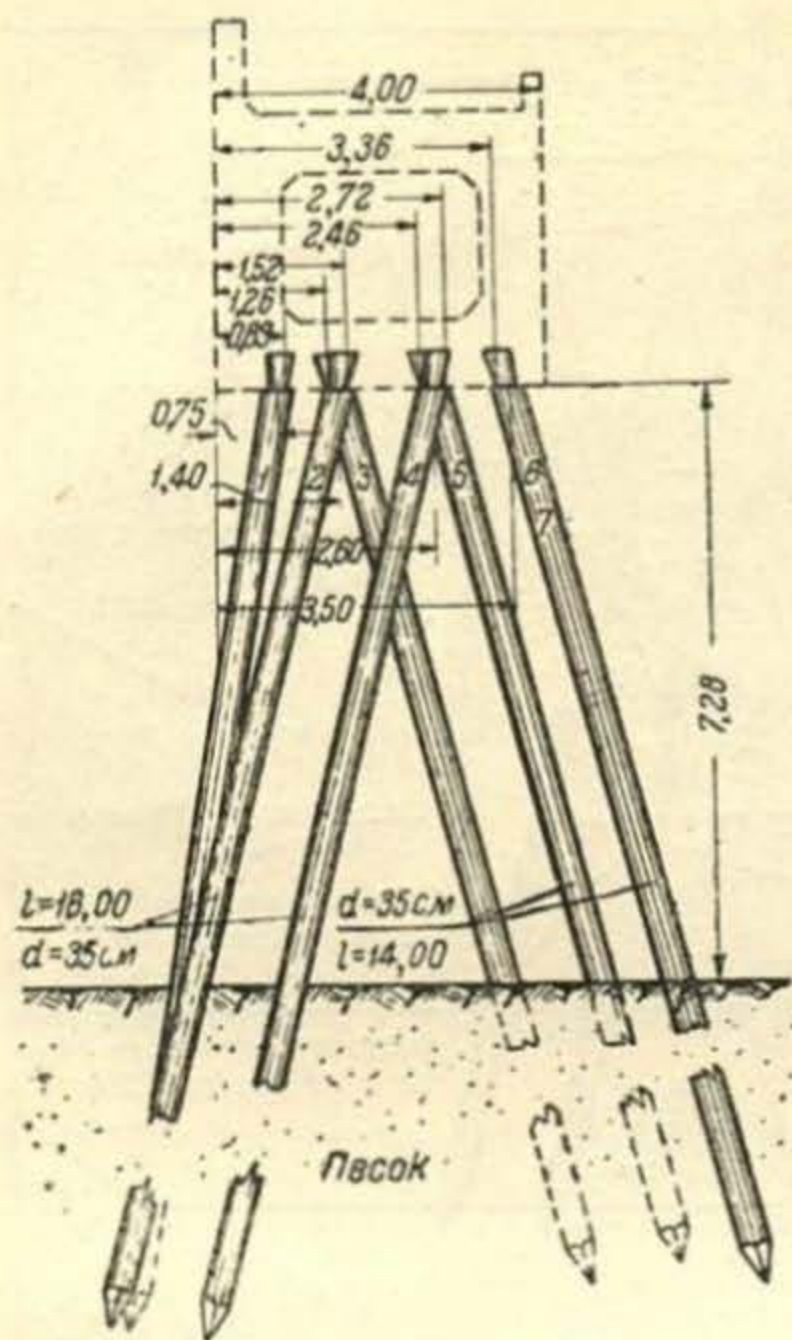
а. План типовой секции свайного основания железобетонной эстакады
